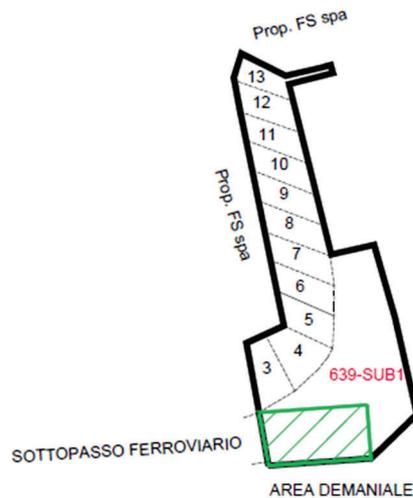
Parcellare 8 - Stralcio dell'elaborato planimetrico con evidenziata la zona di passaggio del camion
